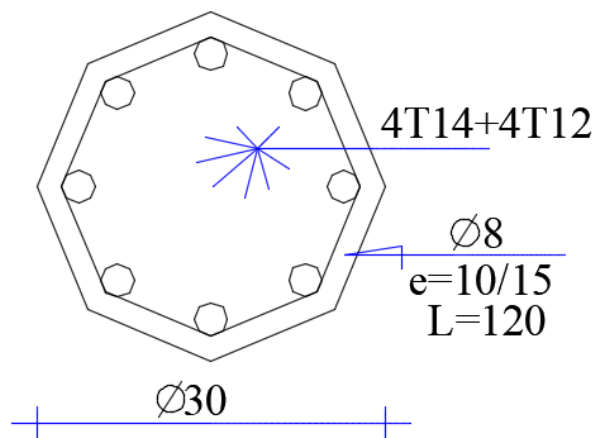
Ferrailage les poteaux circulaire (Ø30) cm
